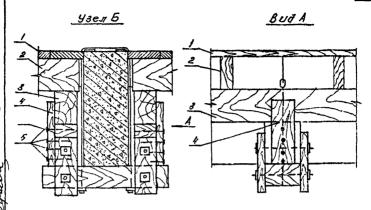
Узел "Б" Вариант по сборным железобетонным балкам перекрытия.
